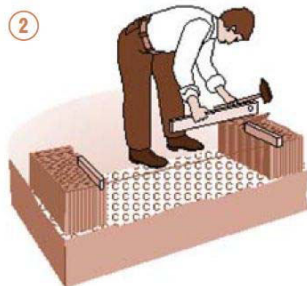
Korekce výškových odchylek podkladní konstrukce
